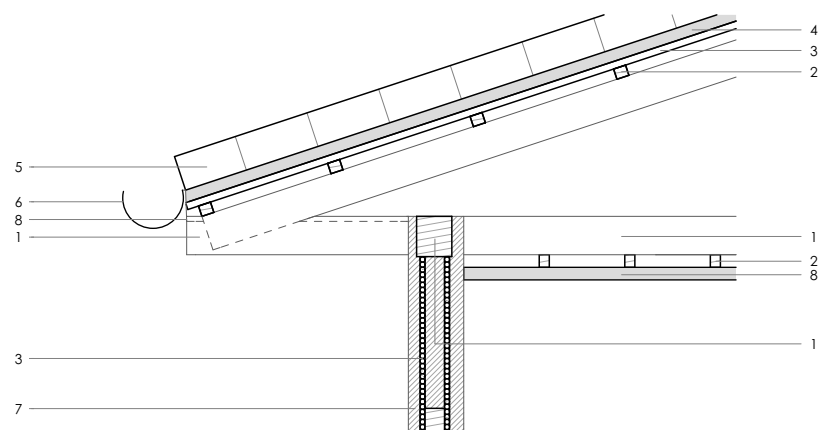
Detalle Constructivo 01. Esc. 1:50
